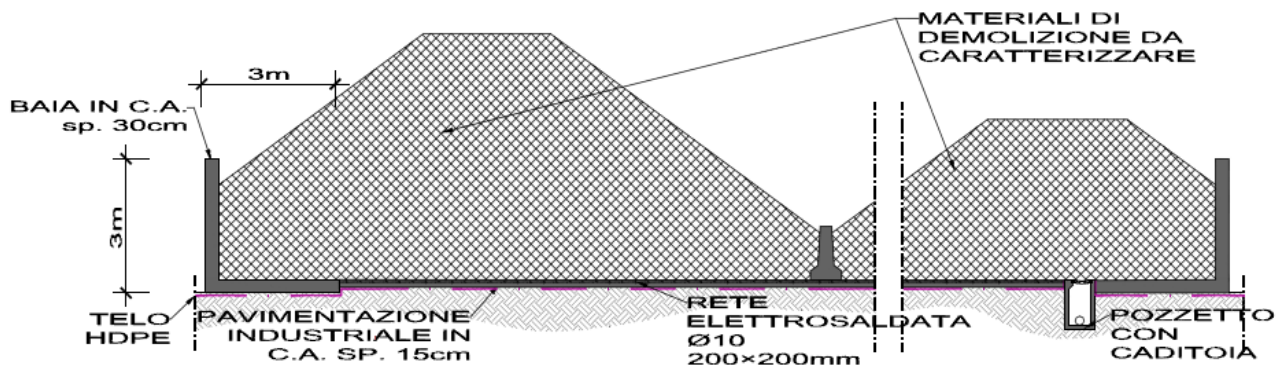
, Sezione tipica Aree di stoccaggio Tipo A
